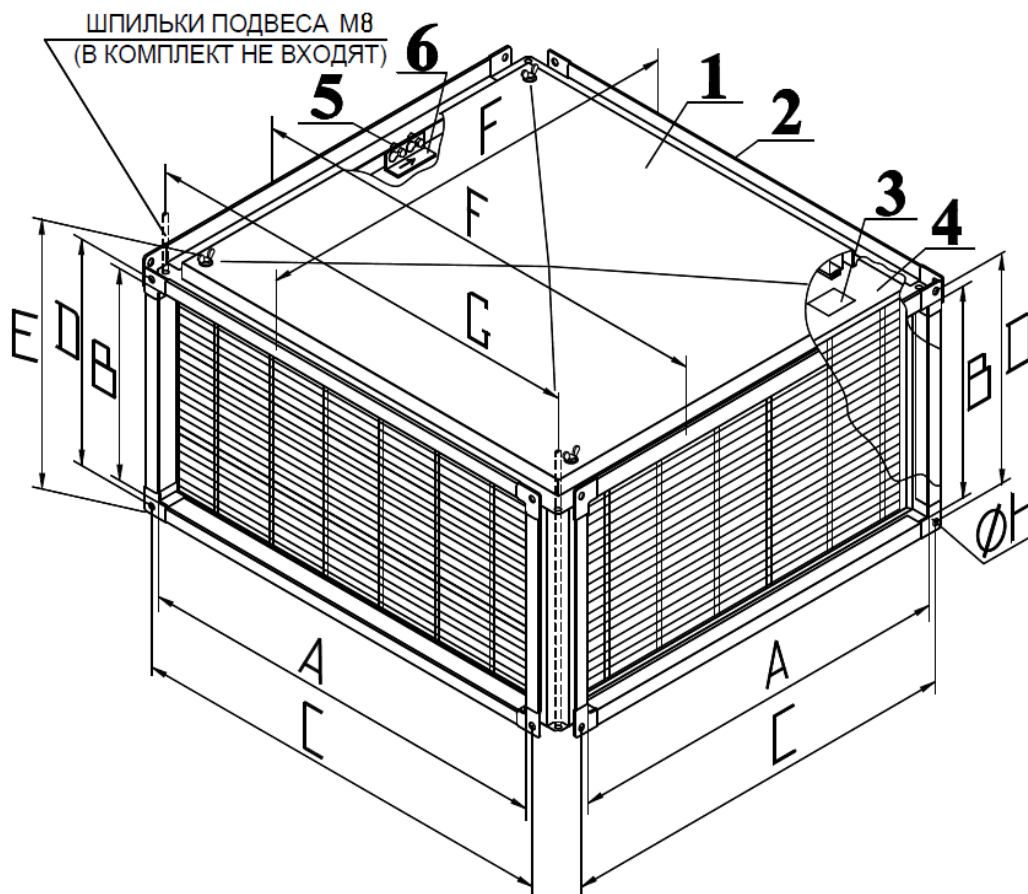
Внешний вид и основные размеры рекуператоров KR
